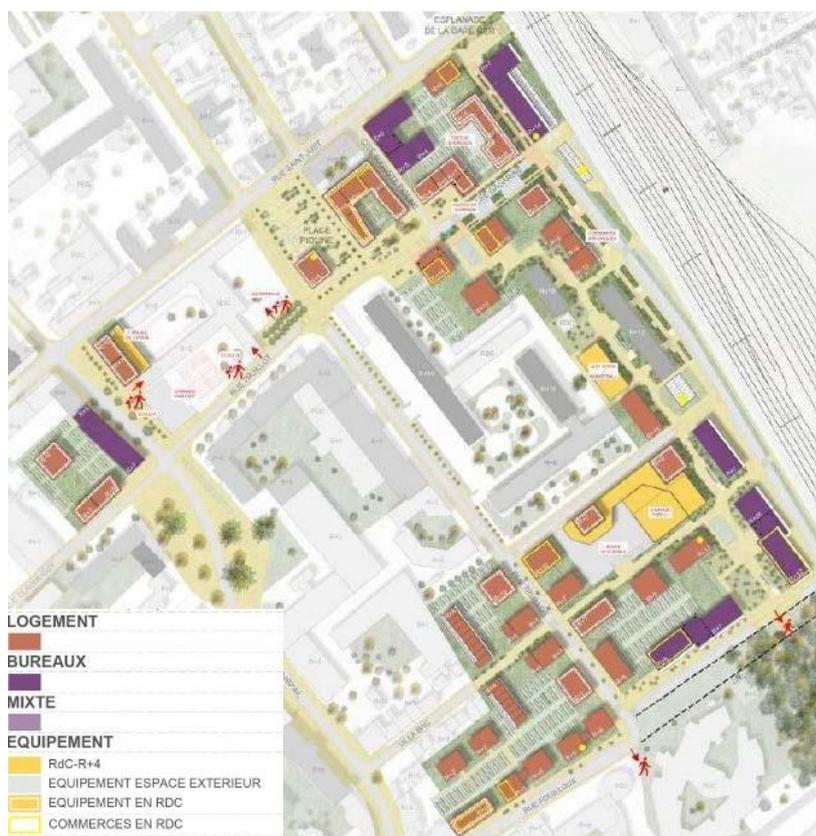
Plan de masse du projet de ZAC Gagarine Truillot. (Source : dossier)
